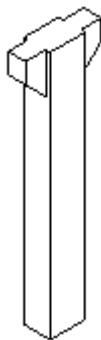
Pilar prefabricat del centre del forjat. (Font: "Revit")
